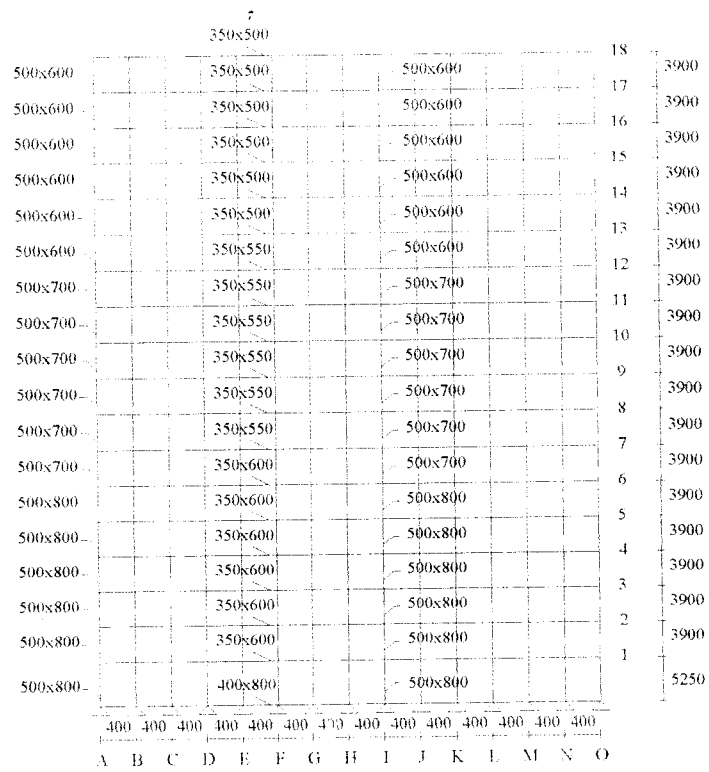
Denah tampak melintang portal as A dengan *shear wall
